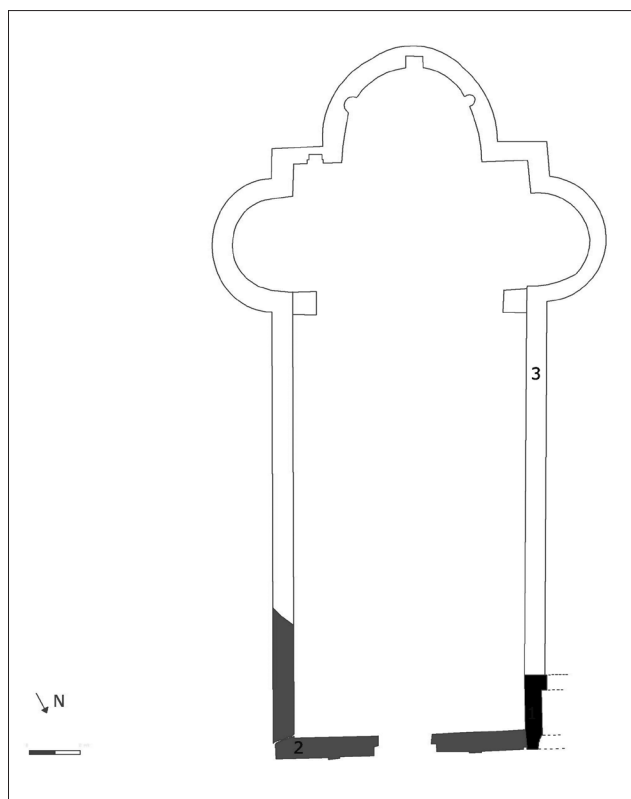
Pianta dell'edificio con localizzazione del paramento Tipo II.
